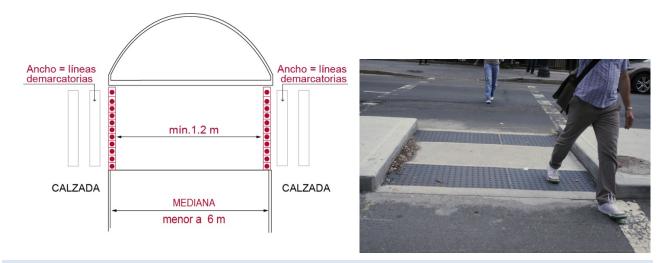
Mediana de ancho menor a 6 m que mantiene todo el ancho del cruce al nivel de la calzada. Foto 6: Mediana rebajada a nivel de la calzada con pavimento de alerta en el inicio y término de ésta.
